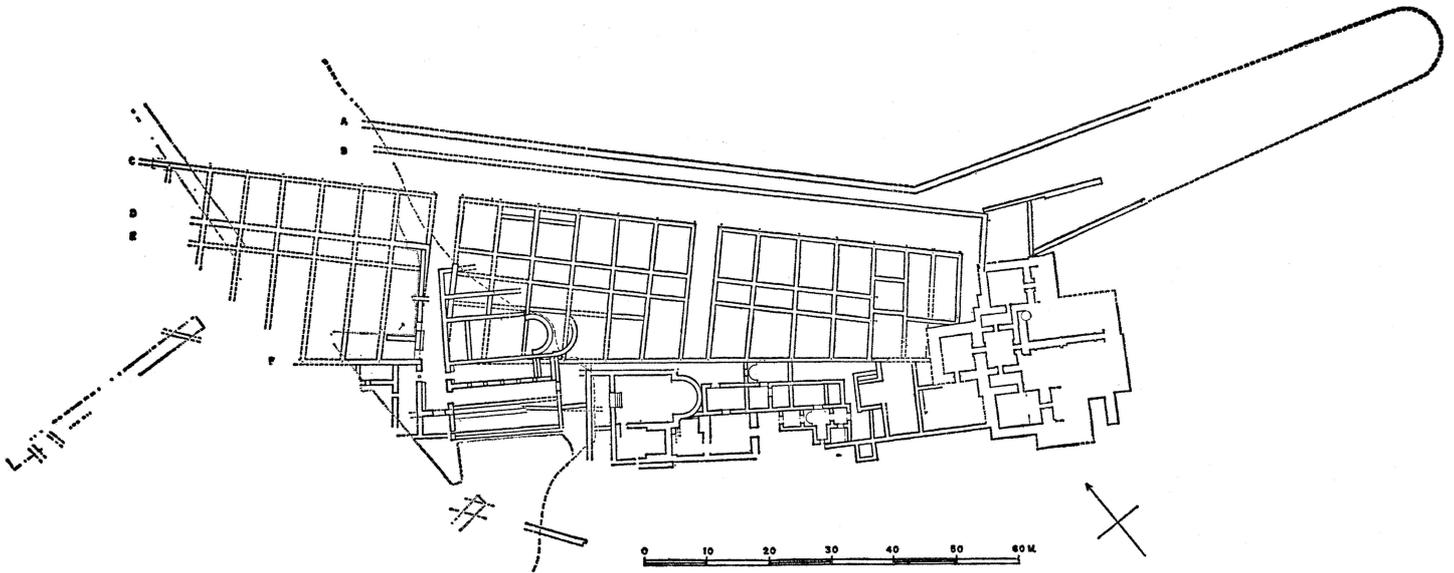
Schema generale della Banchina Sud (Scranton, Ramage, 1967, fig.2)
